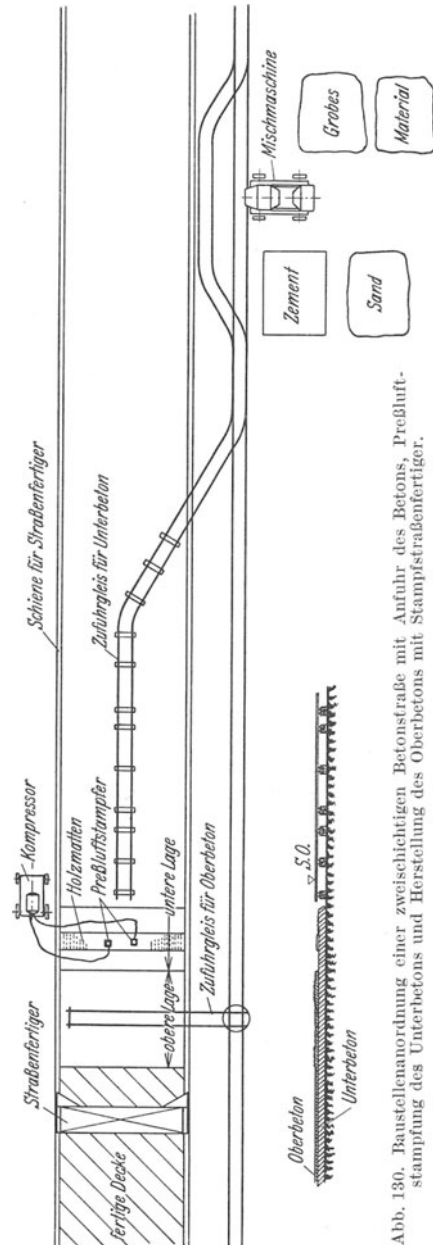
Baustelleneinrichtung einer zweischichtigen Betonstraße mit Anfuhr des Betons, Preßluftstamping des Unterbetons und Herstellung des Oberbetons mit Stampstraßenfertiger.
